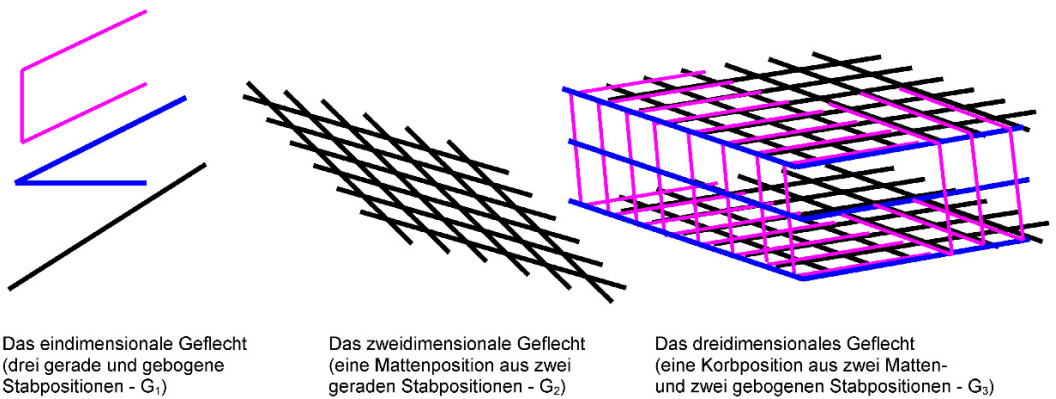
Gegenüberstellung der abstrakten drei Geflechtarten oder der Betonstahlhalbprodukte mit dem Betonstahlprodukt
